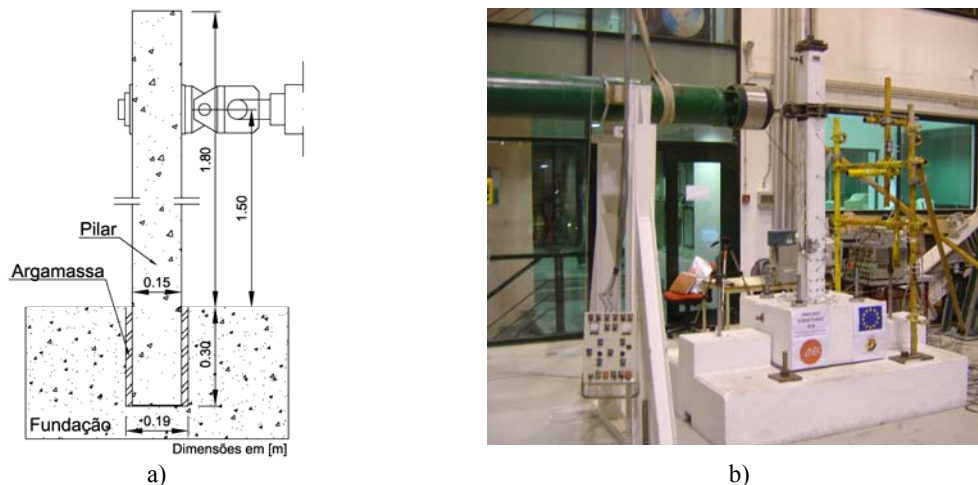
Esquema da ligação pilar-fundação e vista geral da configuração de ensaio.
